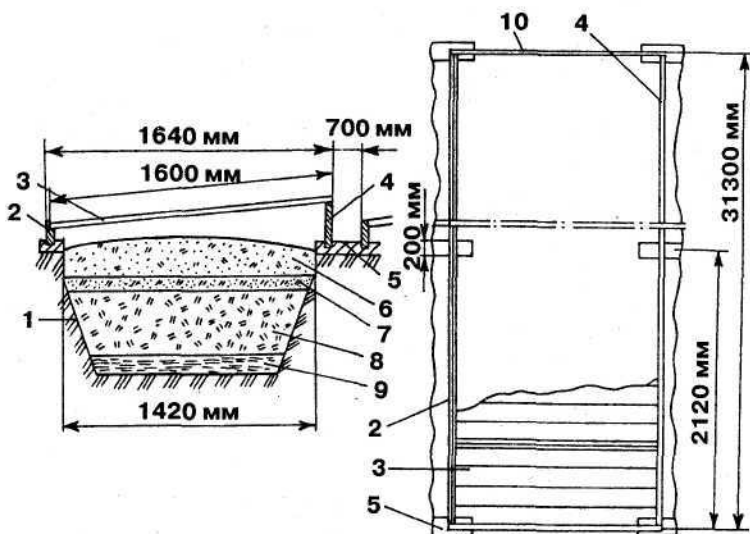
Стандартный односкатный углубленный парник: 1 — котлован; 2 — южный парубень; 3 — парниковая рама; 4 — северный парубень; 5 — лежень; 6 — питательная смесь; 7 — земля; 8 — биотопливо; 9 — солон; 10 — торцовый парубень
